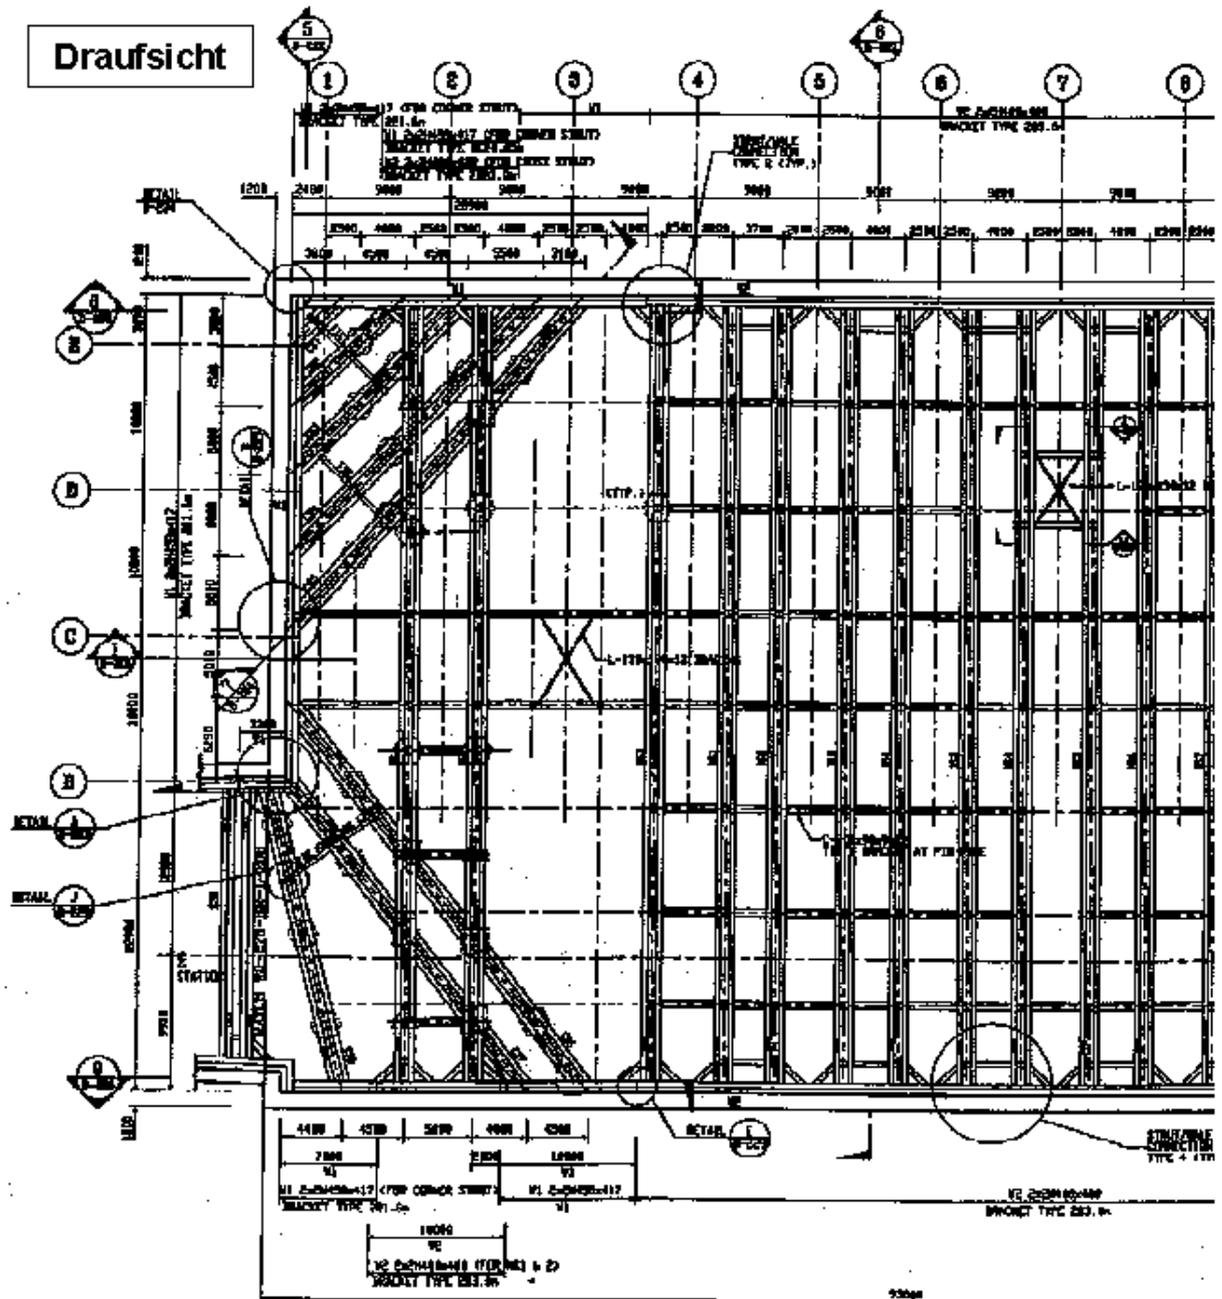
Aussteifungsroste eines U-Bahnhofes in offener Bauweise im Übergangsbereich zur offenen Linienbaugrube
